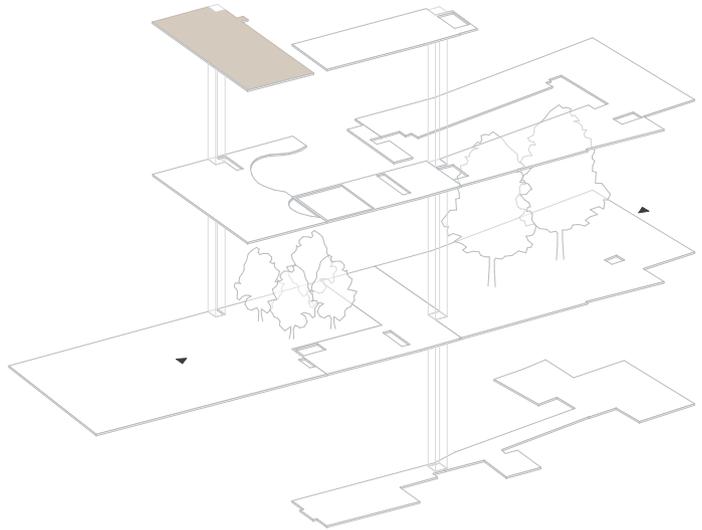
| Grundriss 1. Obergeschoß. Boarding-House (10)
